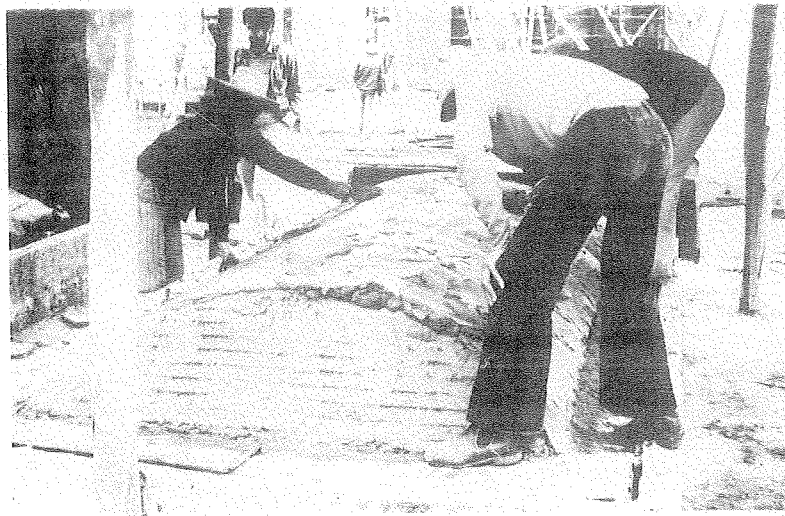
17 - RESERVATÓRIOS DE AMERICANA - MOLDAGEM
